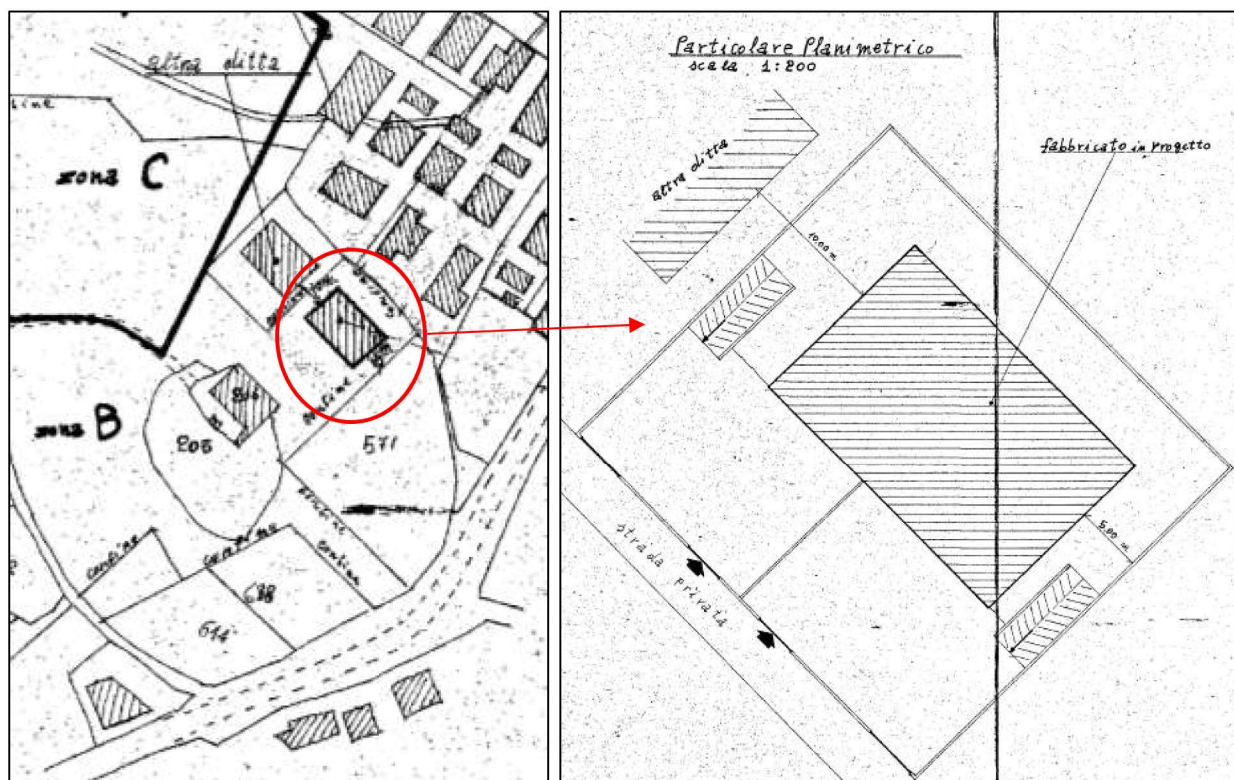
Planimetria generale e particolare planimetrico – Elaborati grafici Concessione Edilizia n.52 del 16/10/1982
